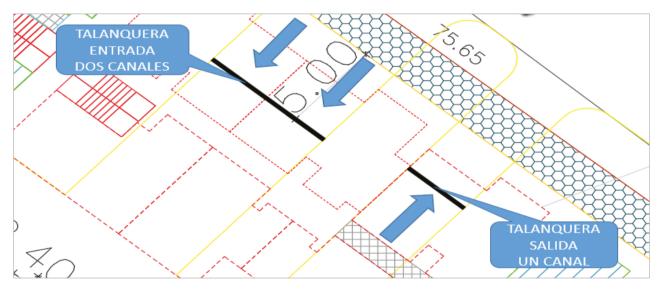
Acceso vehicular Fuente: FS Proyectos de ingenierías S.AS
